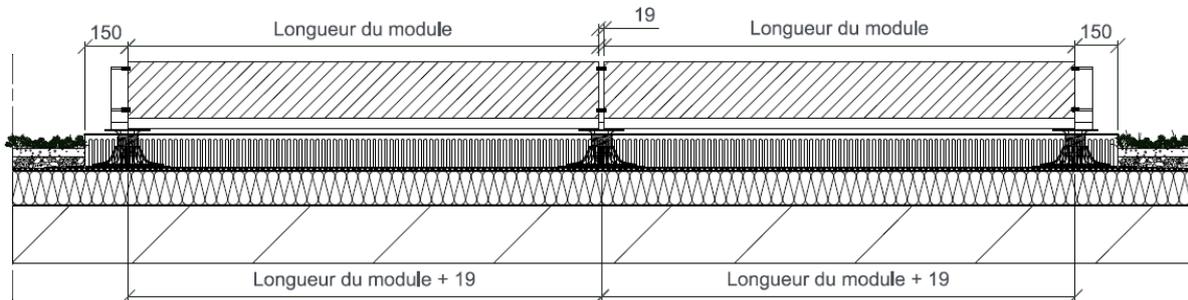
Vue en coupe frontale du procédé SOPRA SOLAR NATURE calepinage paysage
